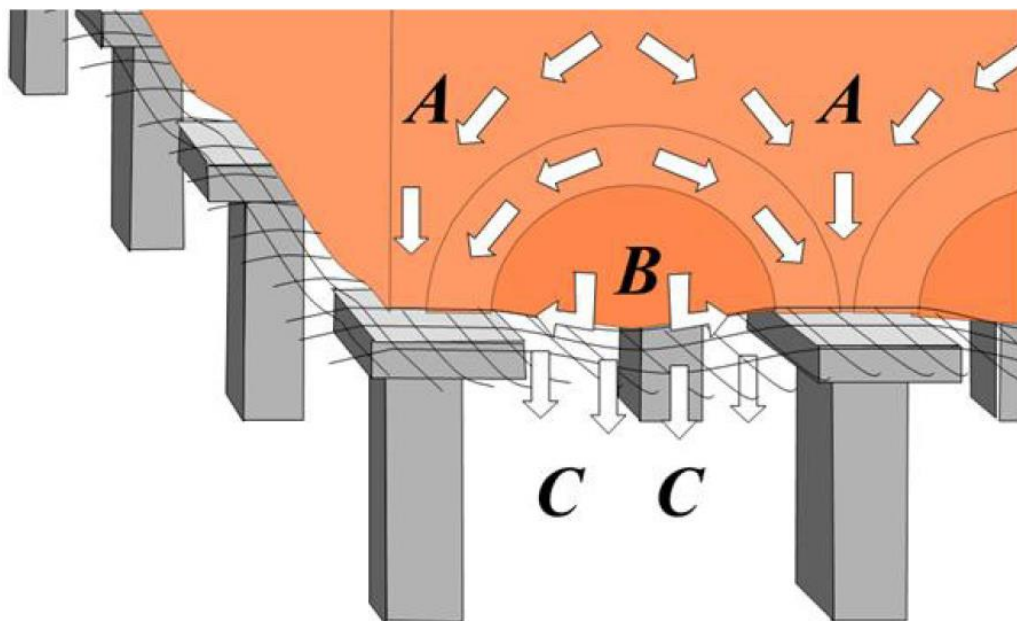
Способ обеспечения устойчивости грунтов сваями и геосинтетической арматурой (распределение нагрузки)
